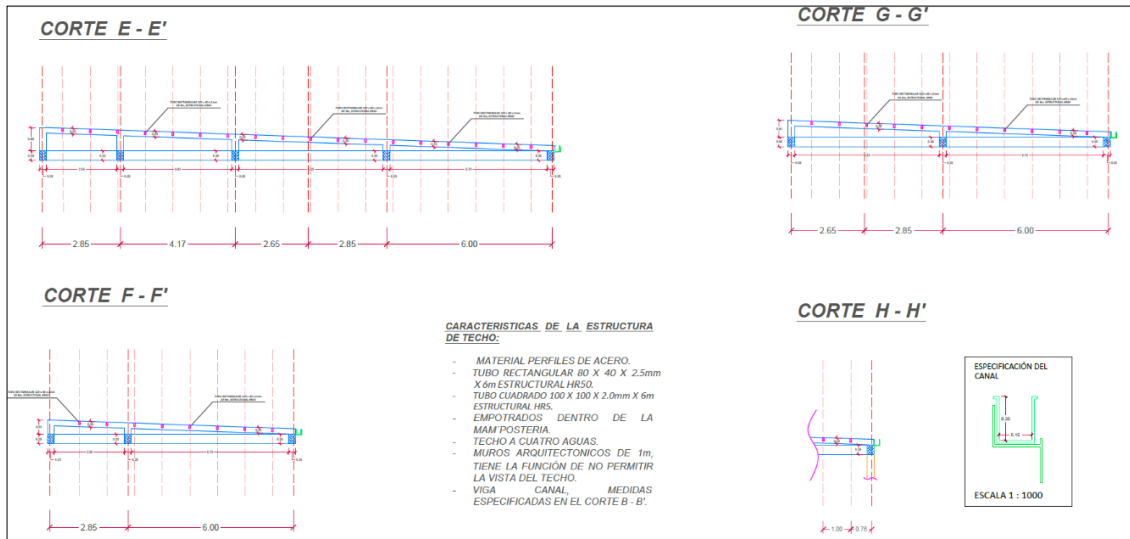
Corte arquitectónico E-E', F-F', G-G' H-H', de la estructura 2 del Centro Vida.
